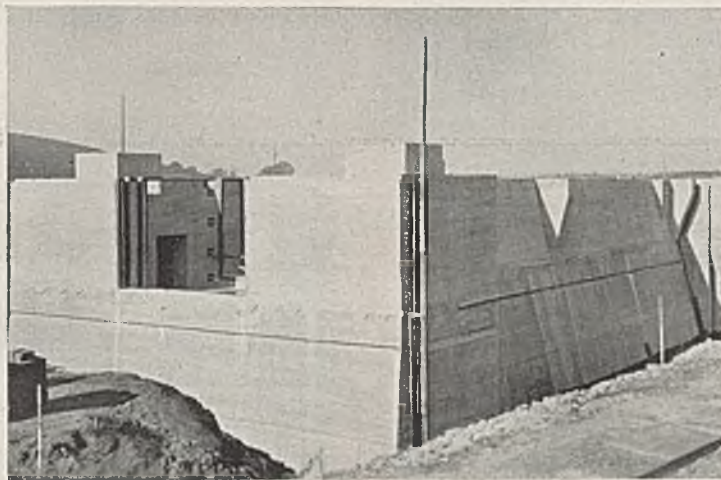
Schachtschleuse Sandhof. Betonbauwerk fertiggestellt.
